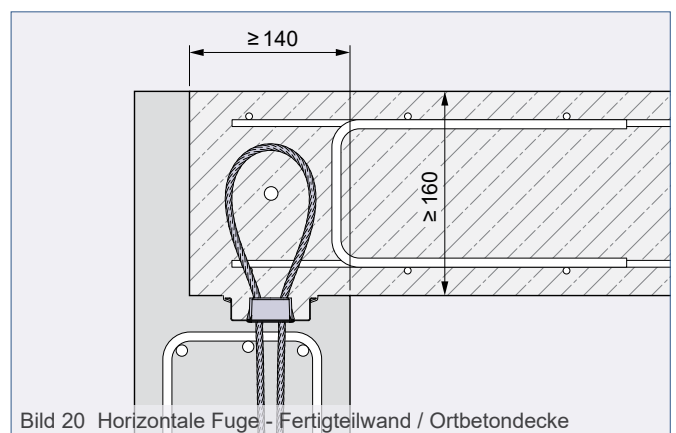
Horizontale Fuge - Fertigteilwand / Ortbetondecke
